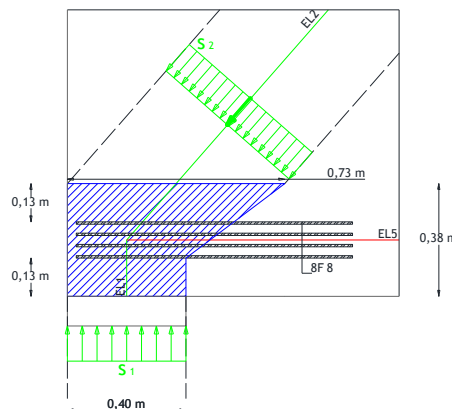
Geometria do nó singular NS1 relativo à zona junto do aparelho de apoio do lado esquerdo da viga parede.
